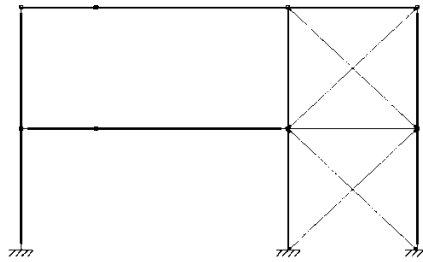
Plano del pórtico de fachada. Fuente: CYPE 3D.
